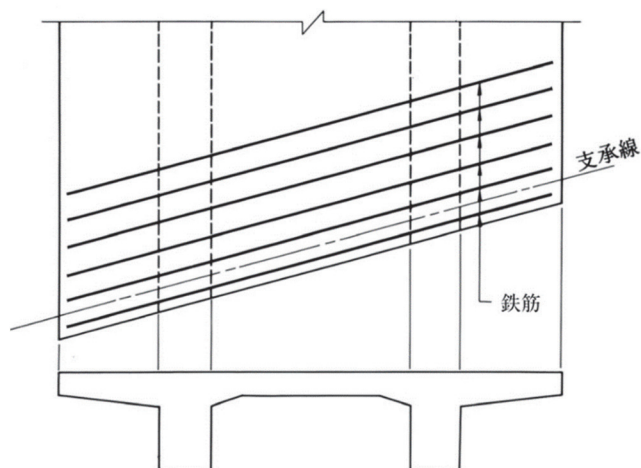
斜橋の支承部付近における鉄筋の配置
